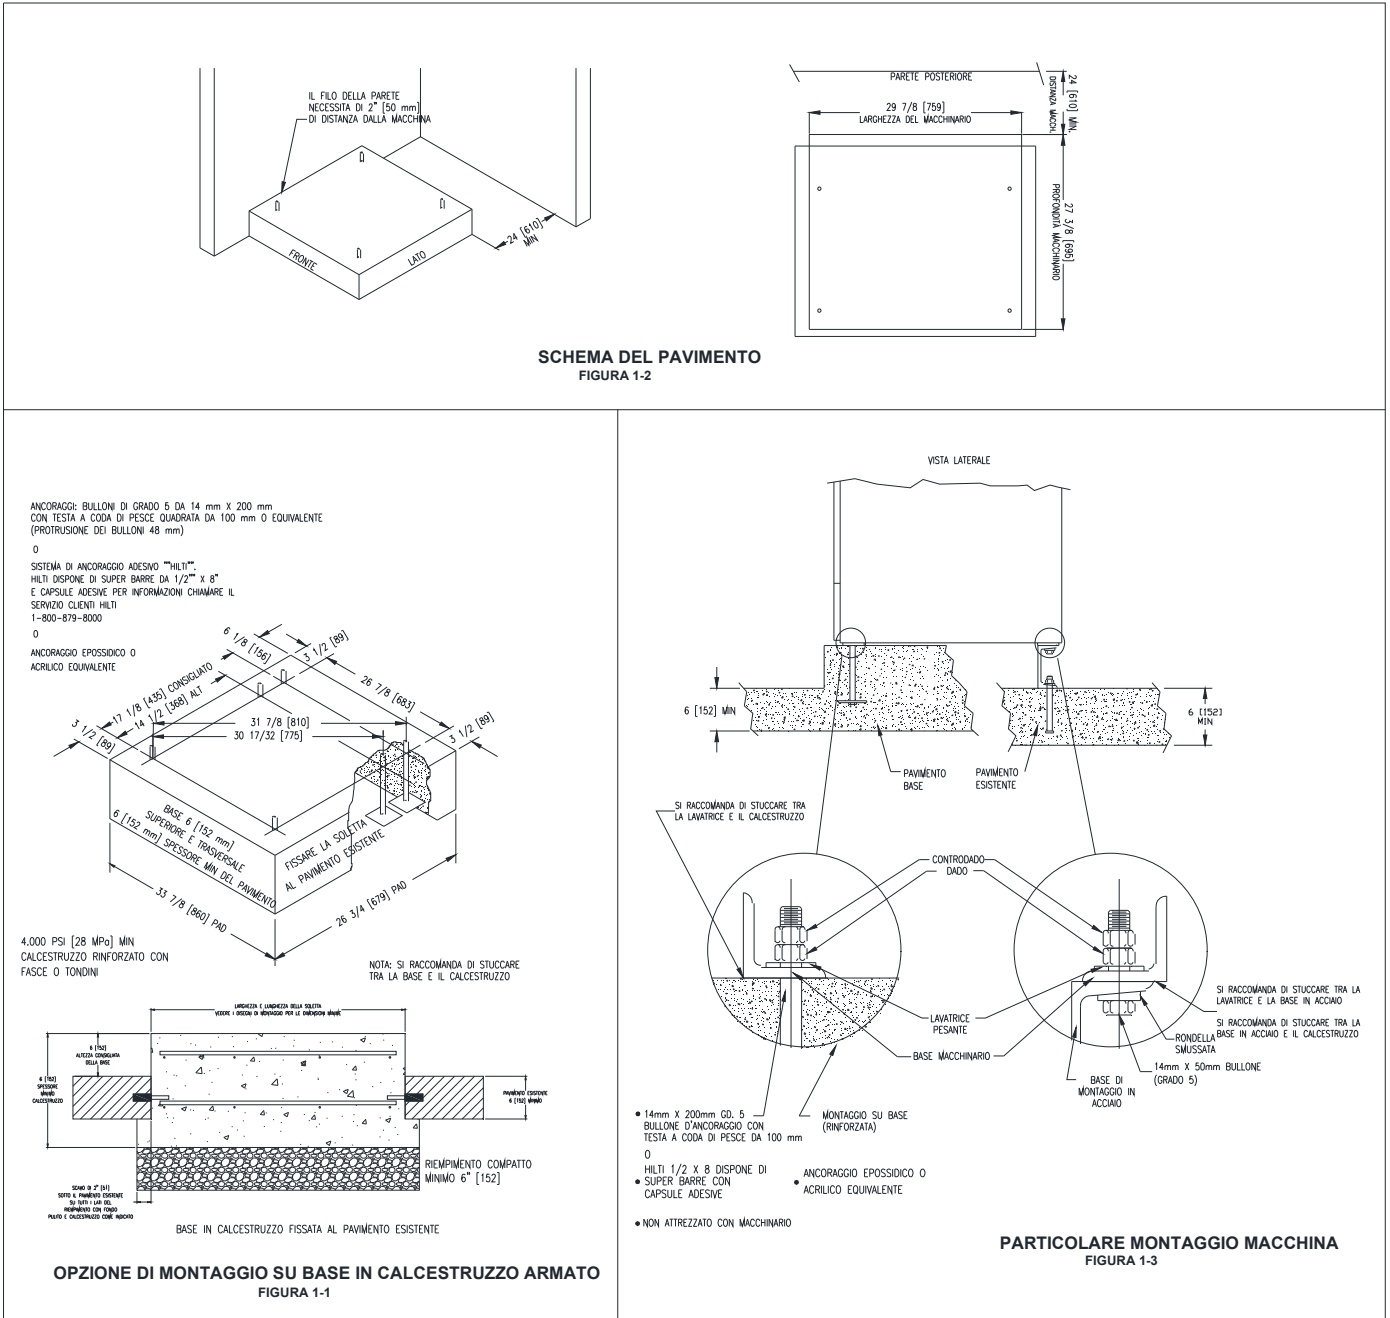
Dettaglio del montaggio del macchinario T-400
